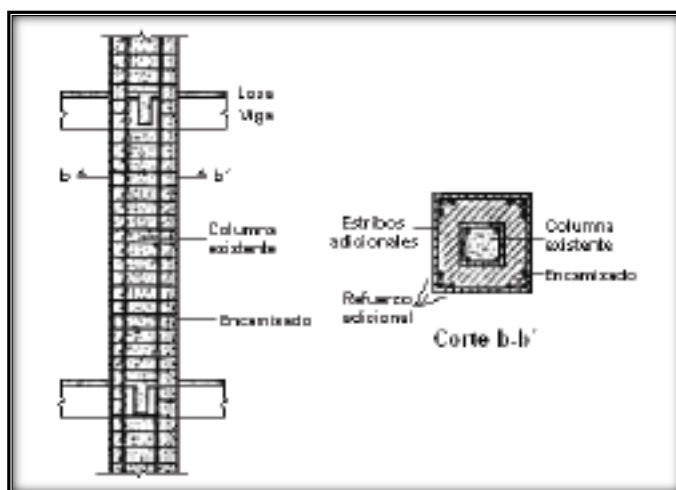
Encamisado de una columna que atraviesa la losa (Asumida en el Análisis)
